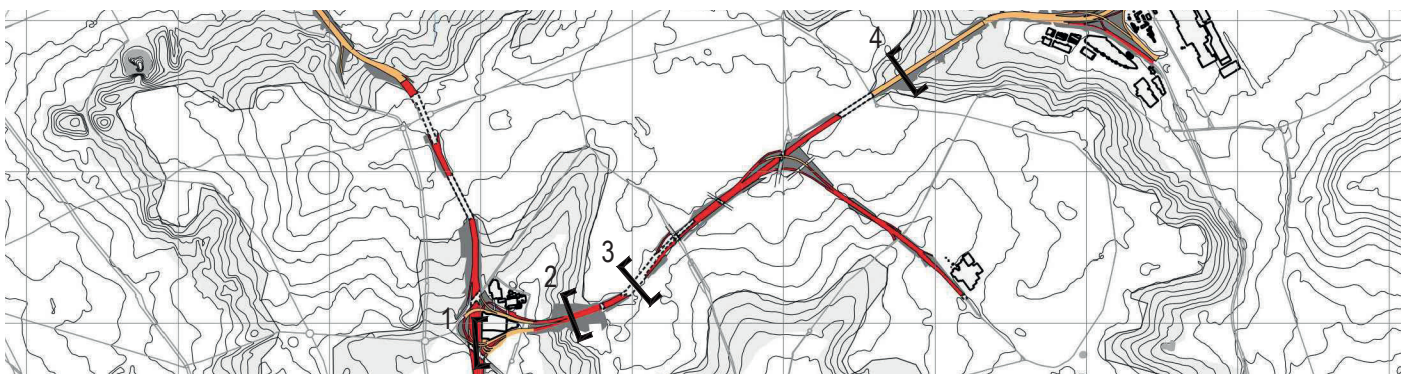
Coupes transversales de la traversée par l'autotoute A3.
